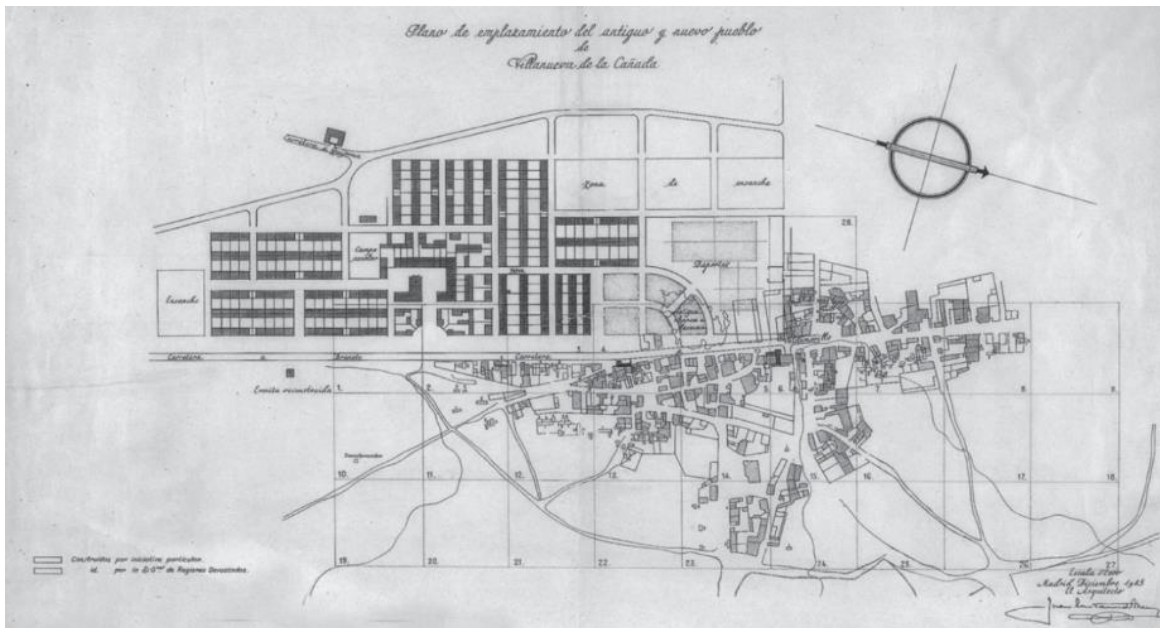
Propuesta de Proyecto de situación del nuevo pueblo con respecto a las ruinas del antiguo pueblo. 1945. Fuente: Archivo General de la Administración.
